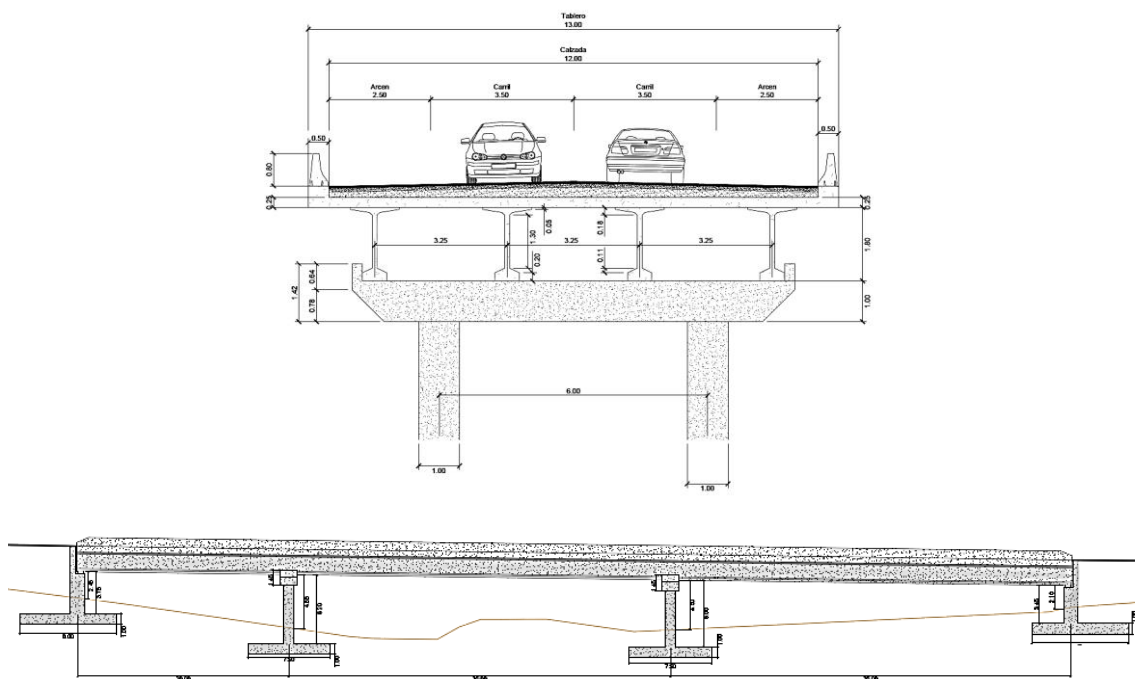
Sección tipo y sección longitudinal del Puente 3
